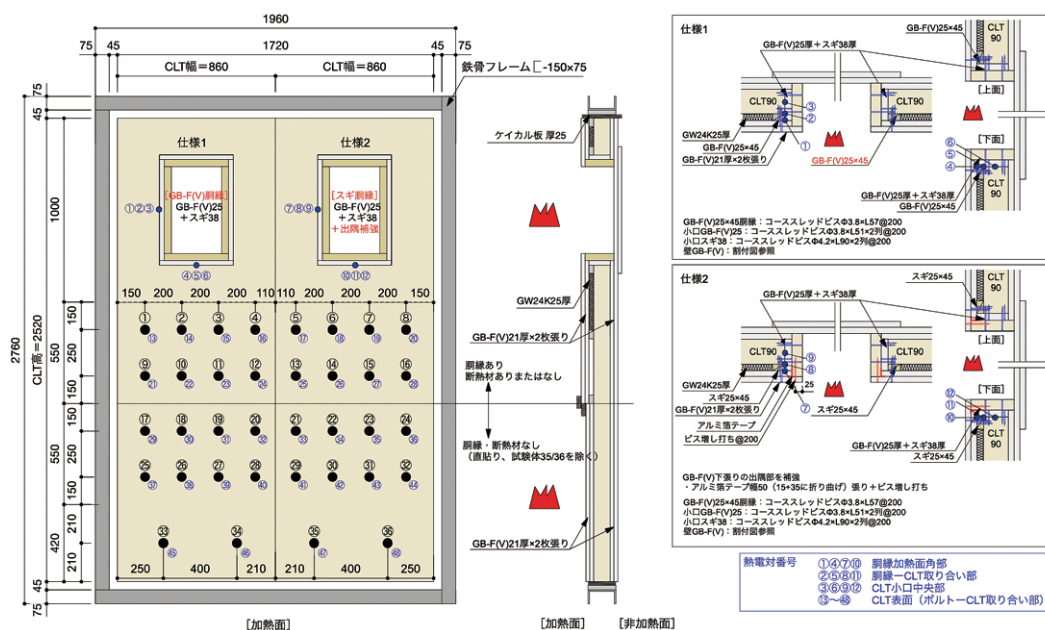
試験体①の寸法・構造・温度測定位置 (単位 mm)
